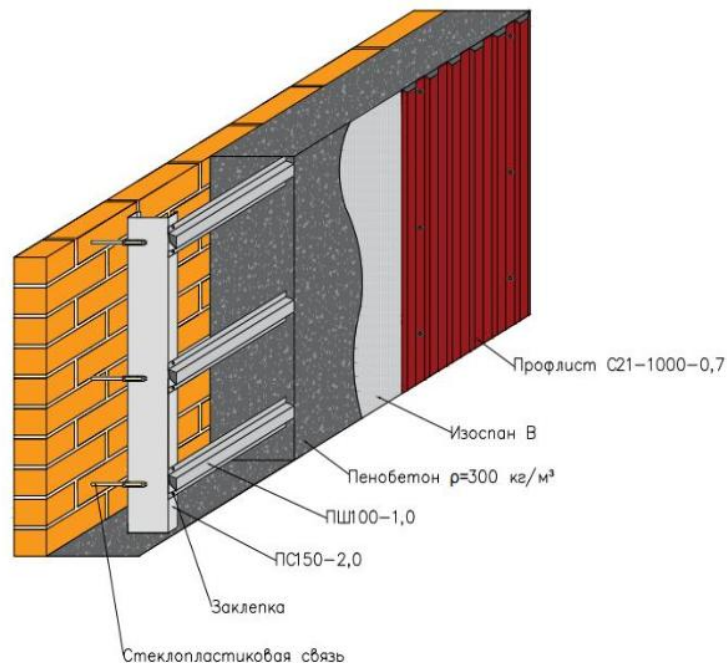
Фасадная система из пенобетона и металлического профилированного листа
